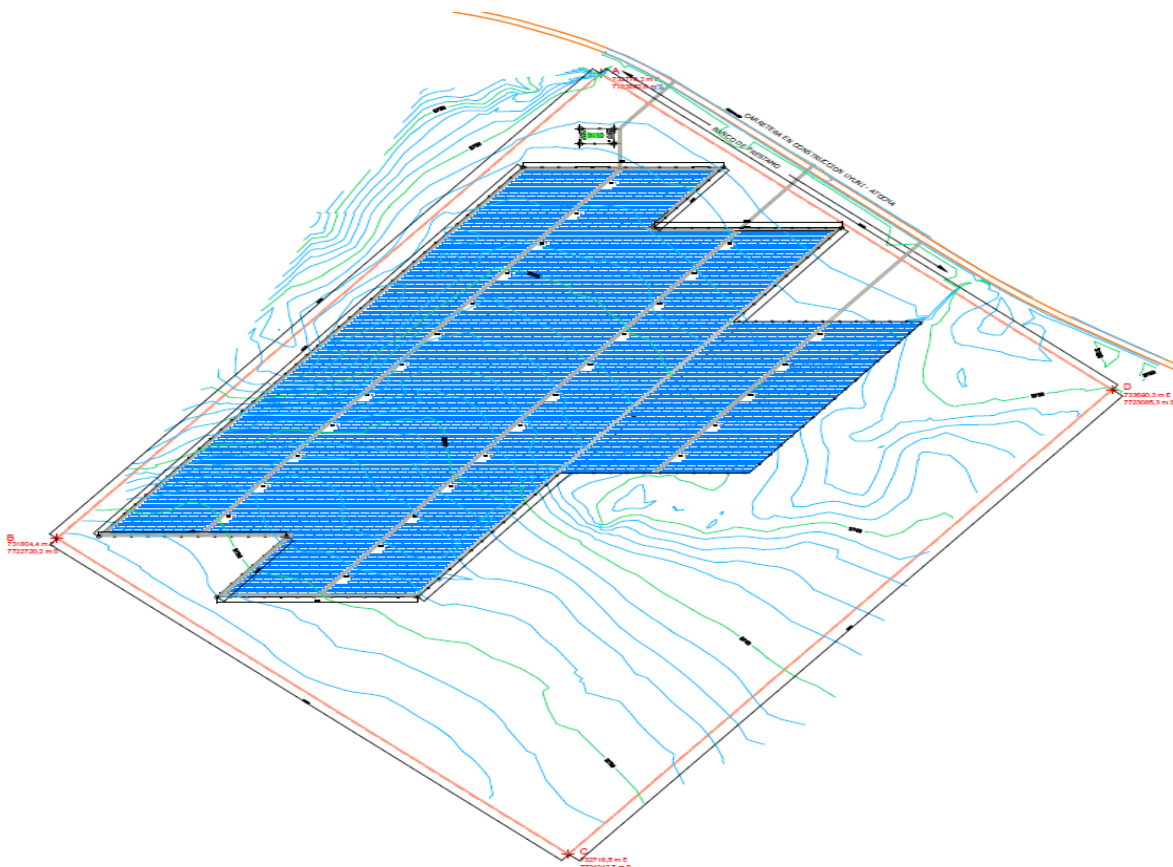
EJEMPLO DEL PLANO DE DISPOSICIÓN DE LA PLANTA
